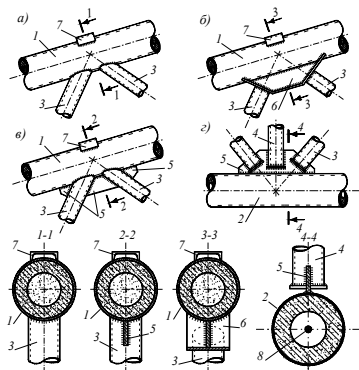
Возможные способы соединения раскосов и стоек с поясами трубобетонной фермы: 1 – верхний пояс; 2 – нижний пояс; 3 – раскосы; 4 – стойка; 5 – косынка; 6 – упорная косынка; 7 – опорный столлик; 8 – предварительно напряженный элемент
